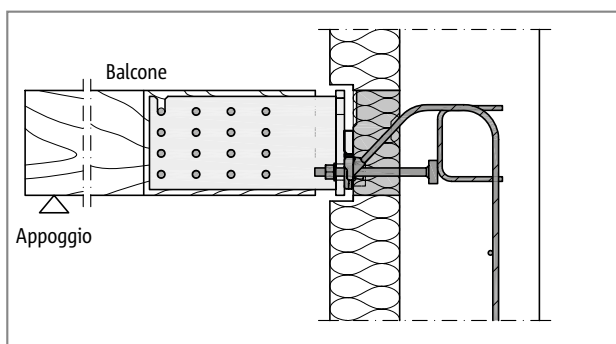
Schöck Isokorb® T tipo SQP-WU con piastra in acciaio: situazione speciale; necessaria per raccordare una parete in calcestruzzo armato
